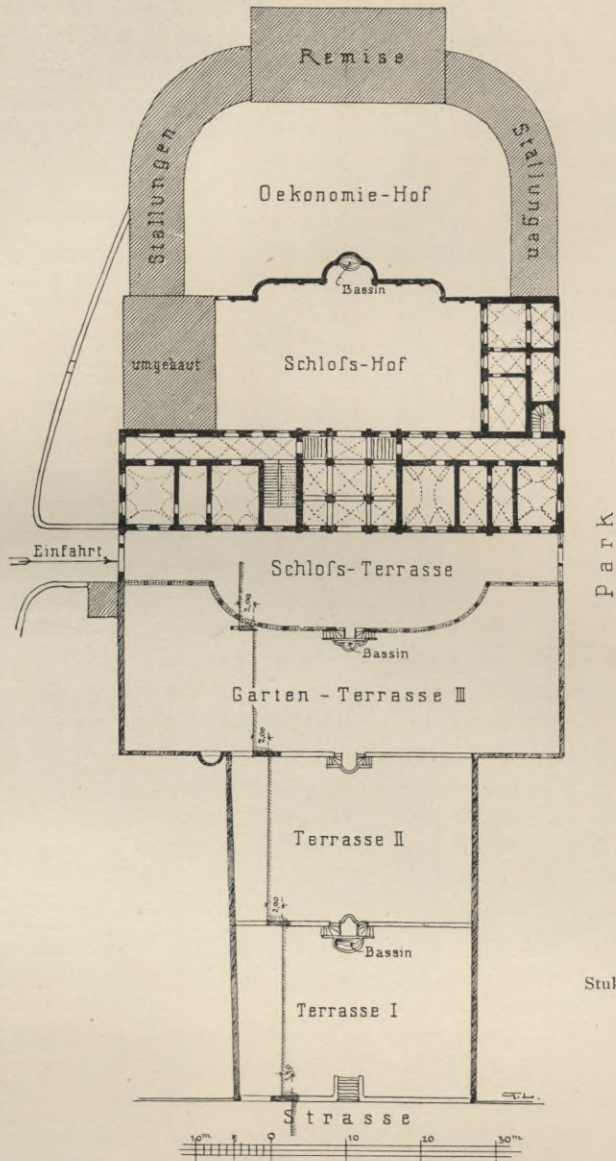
Oberschwappach. Lageplan des Schlosses.
